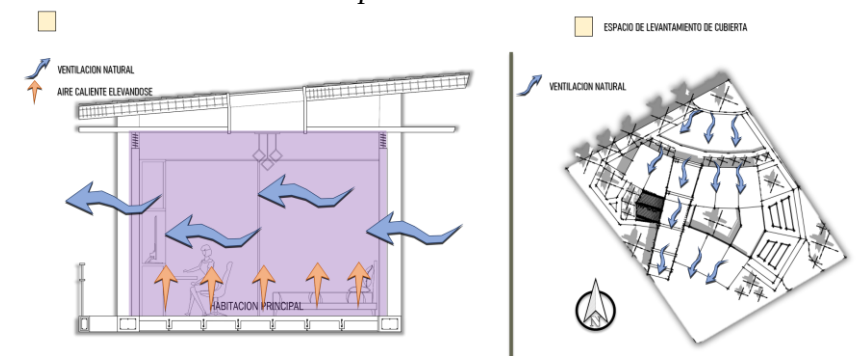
Levantamiento en cubierta en corte / perspectiva
